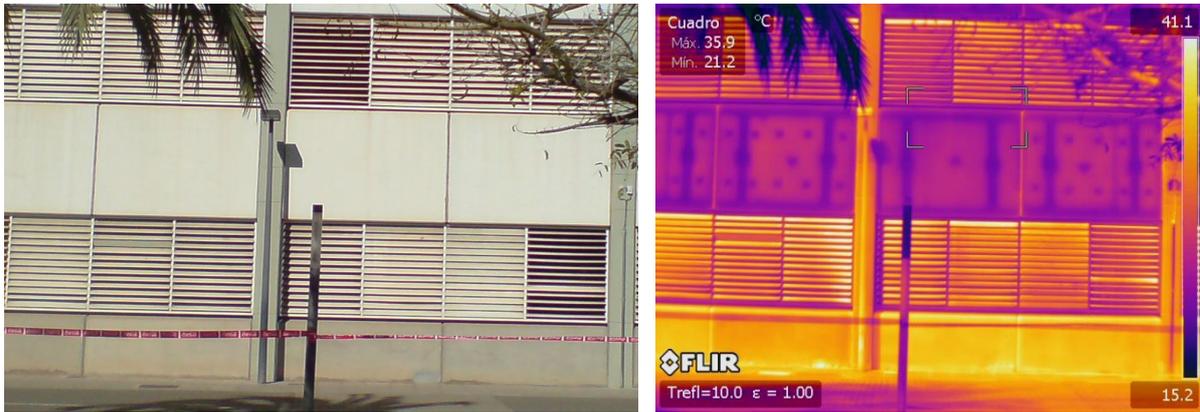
Ejemplo de visualización de estructura interior de aplacado de hormigón armado con termografía infrarroja
